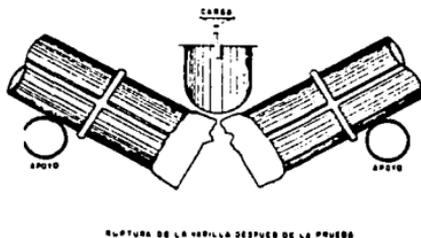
c) Prueba de sanidad en soldadura de ranura en varillas.
